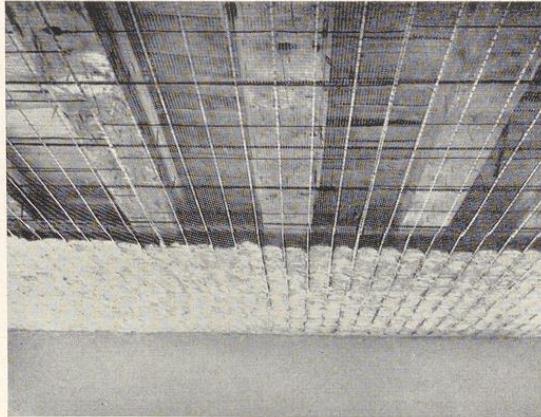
Rabitzdecke mit Baustahlmatten unter Holzgebälk,
